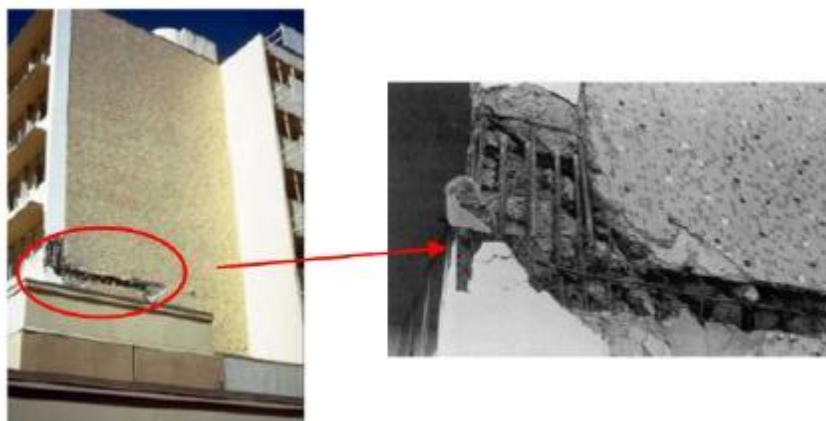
Caída del Concreto y Grietas Horizontales en Muro de Corte
